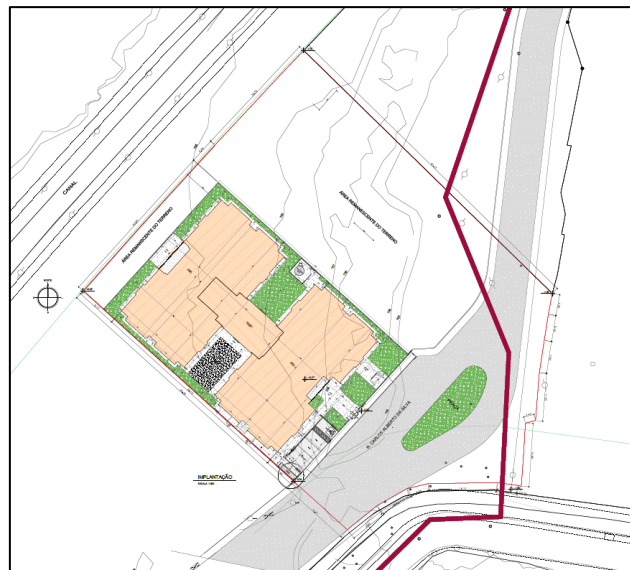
Planta de Implantação (Jd Oratorio Implantação e Topografia)
